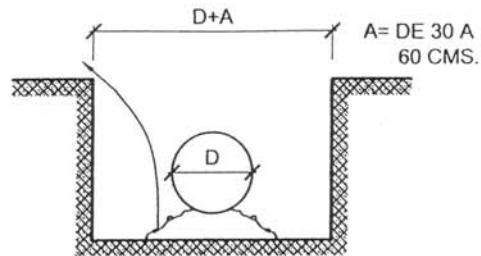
Instrucciones para colocación de alcantarilla anidable con brida
